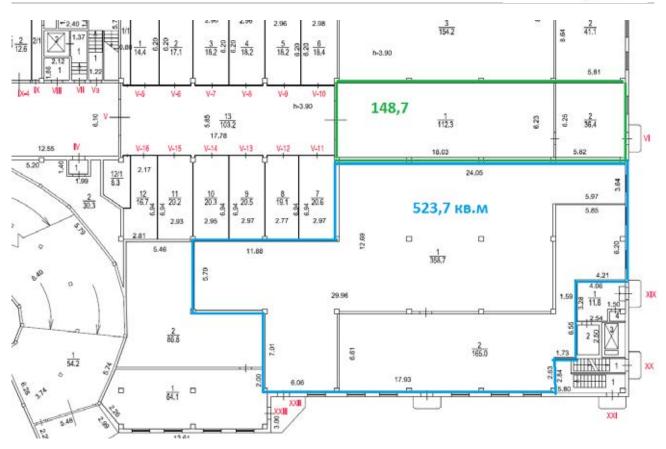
Схема оцениваемых помещений на плане этажа №1
